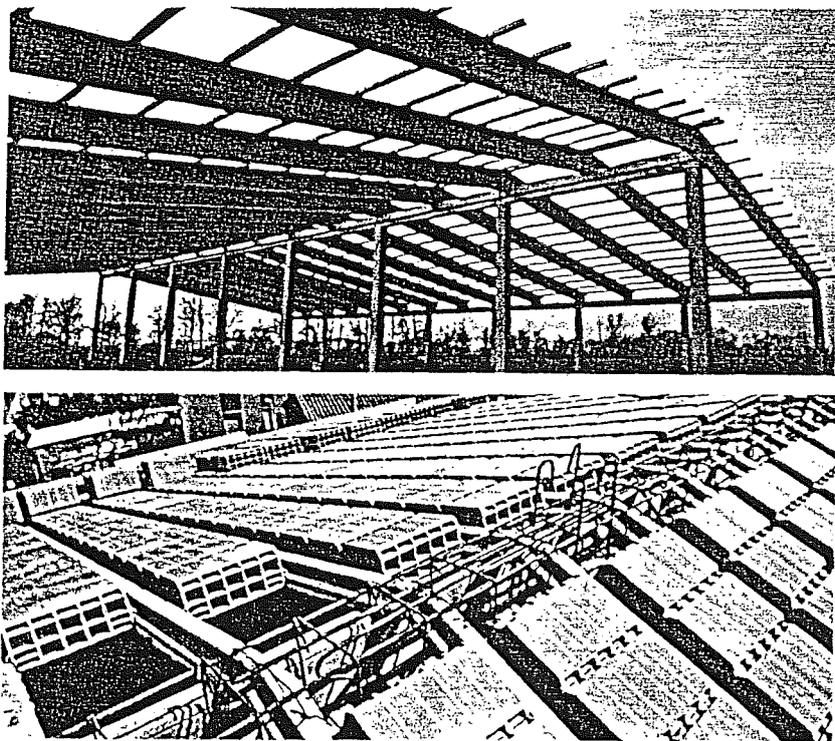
Copertura a falde realizzata con travetti in calcestruzzo precompresso e blocchi collaboranti.
